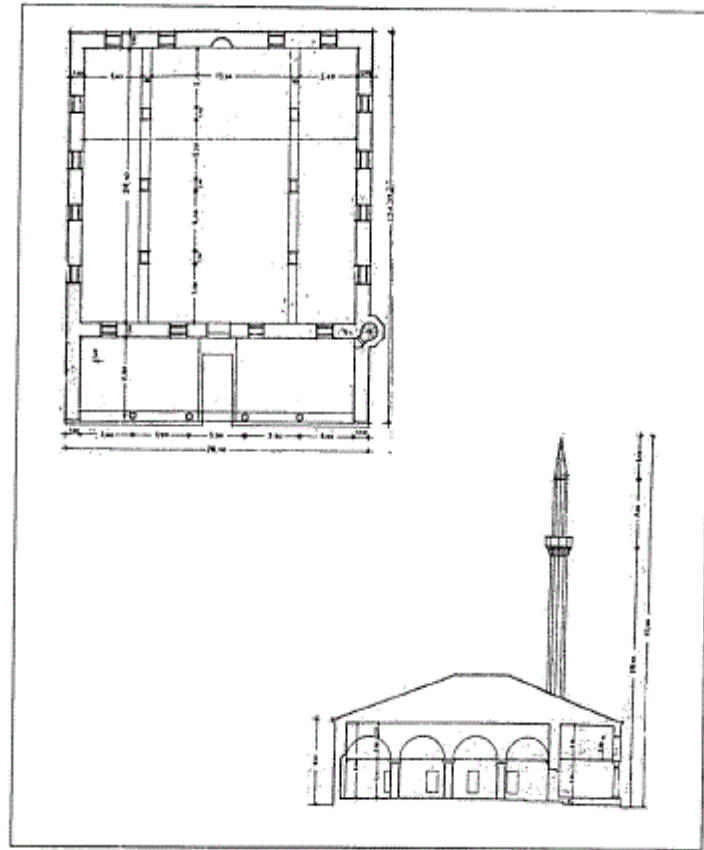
مسقط أفقي لمسجد ذخیرلی فی شیریز بالیونان (عن : کیل)
